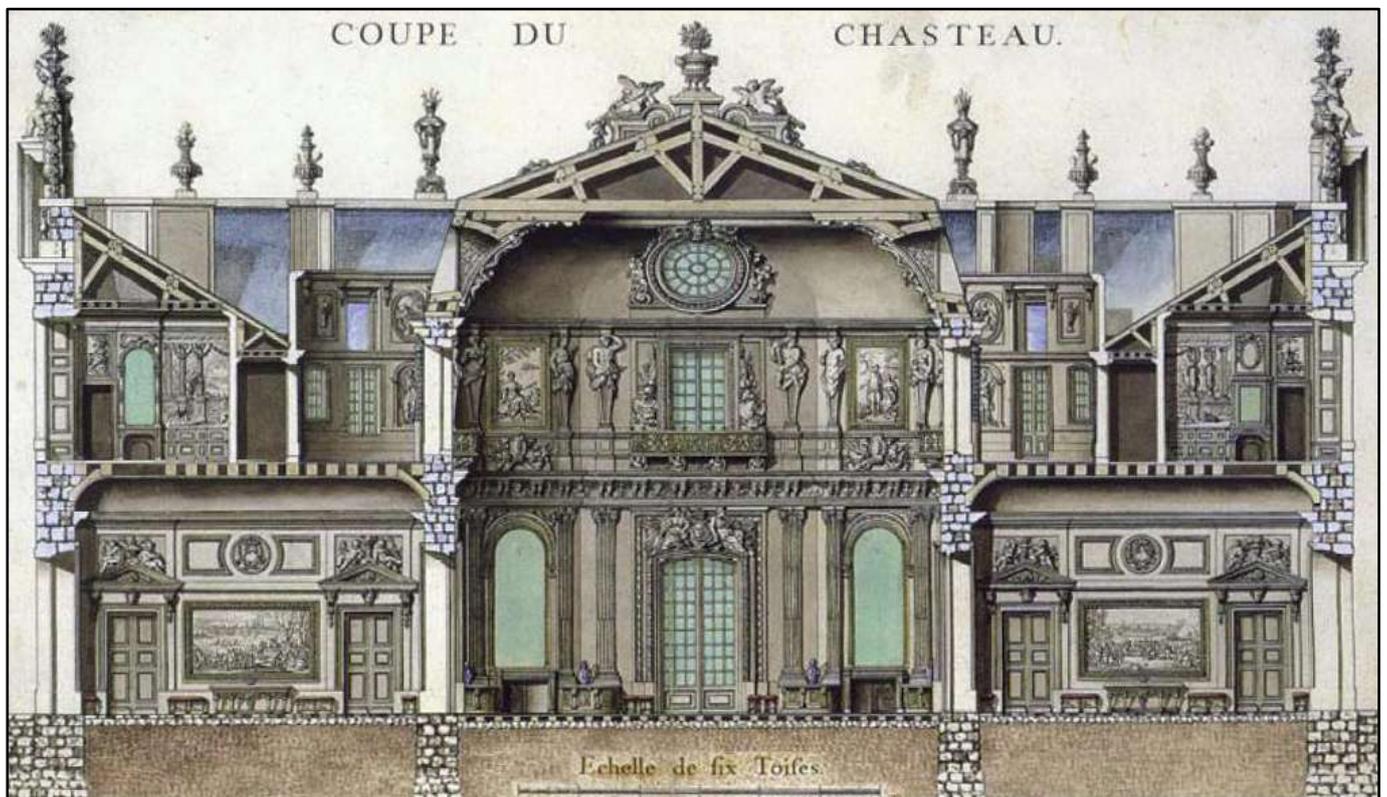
Coupe du pavillon central du château de Marly, 1699.
